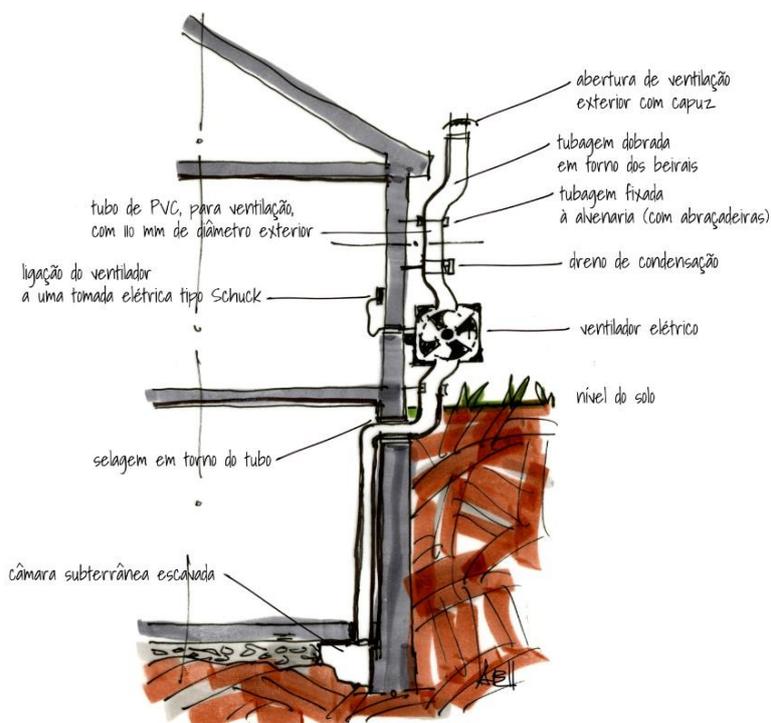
Exemplo de sistema de despressurização do terreno debaixo da laje térrea, instalado numa cave, com condutas e ventilador localizados no exterior
